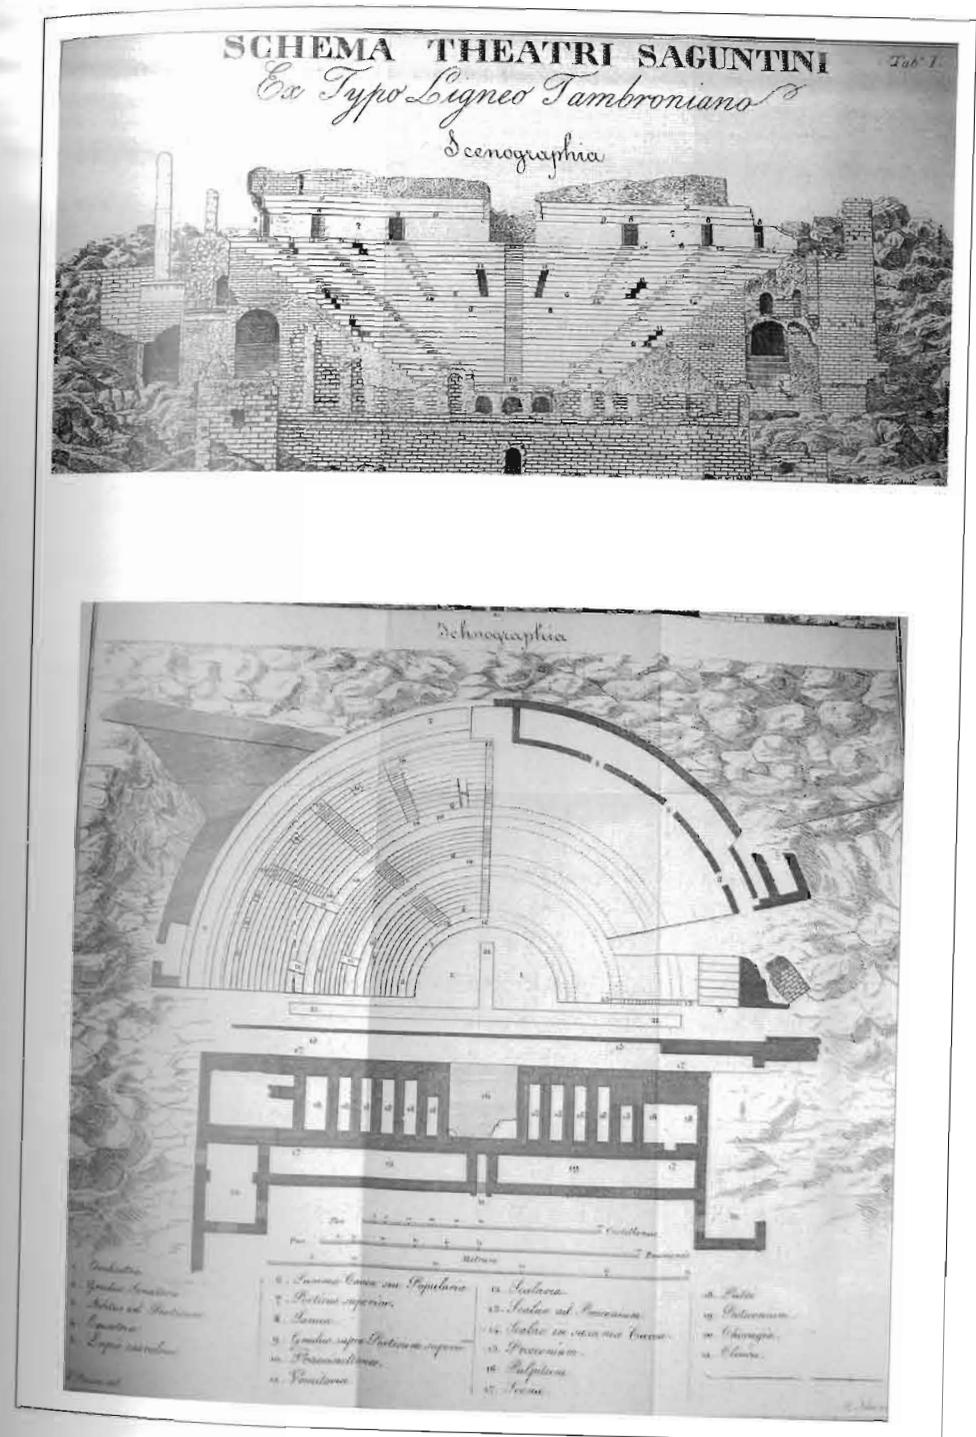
Alzado y planta del teatro de Sagunto, según F. Schiassi.
